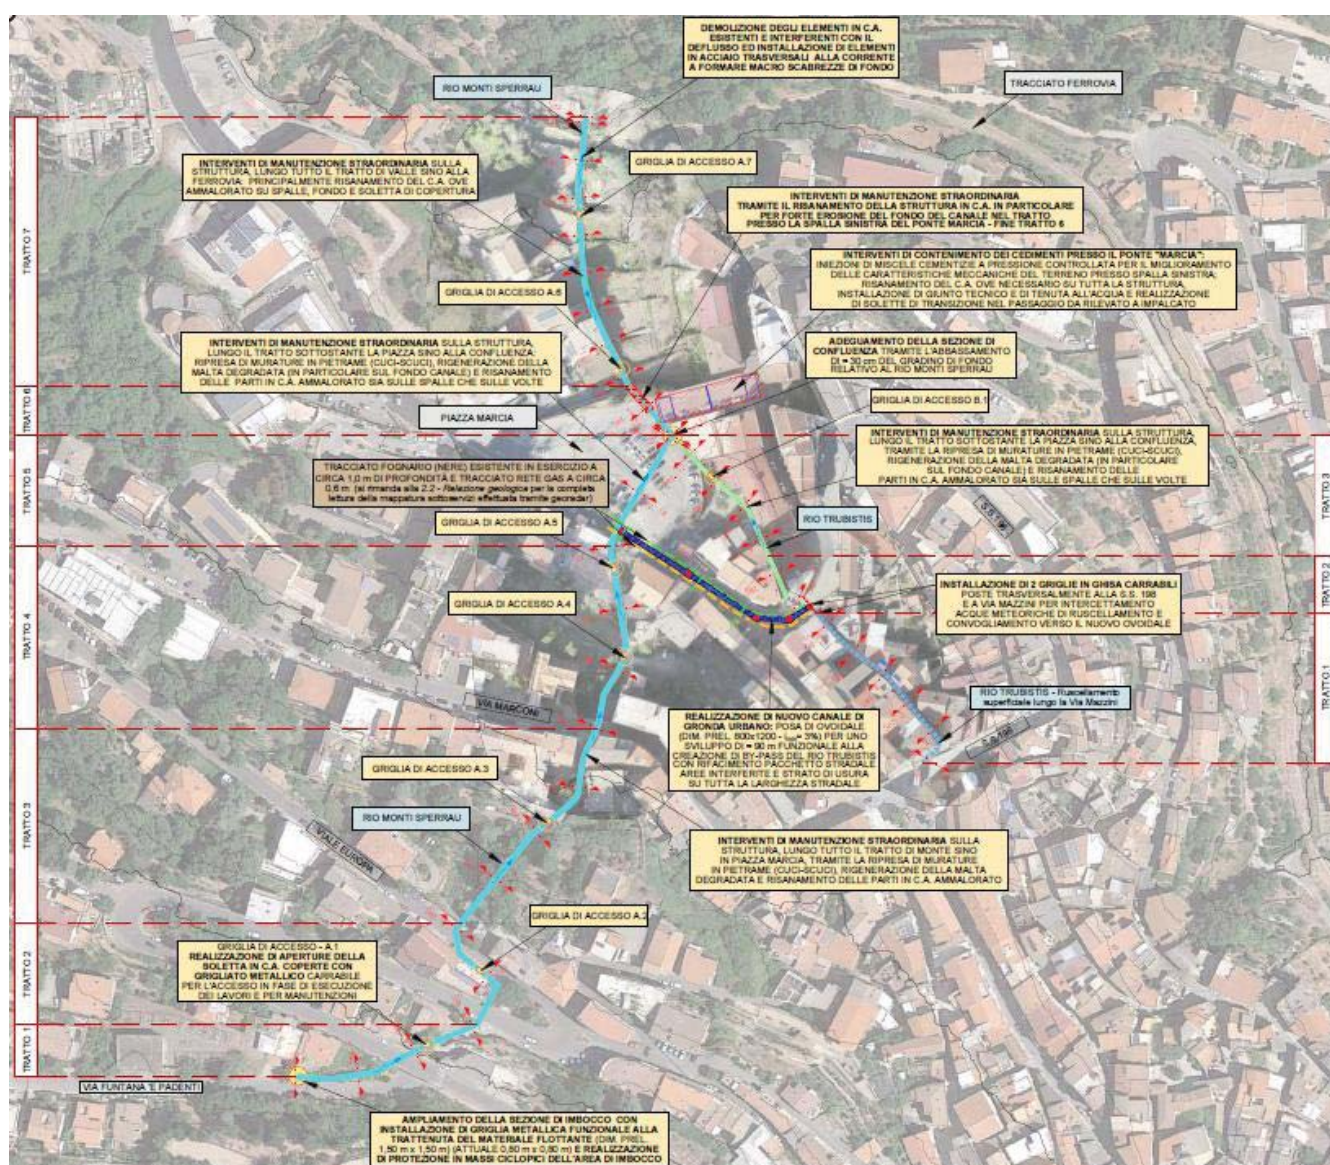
Estratto dell'Elab. 4.3 – Planimetria generale degli interventi
